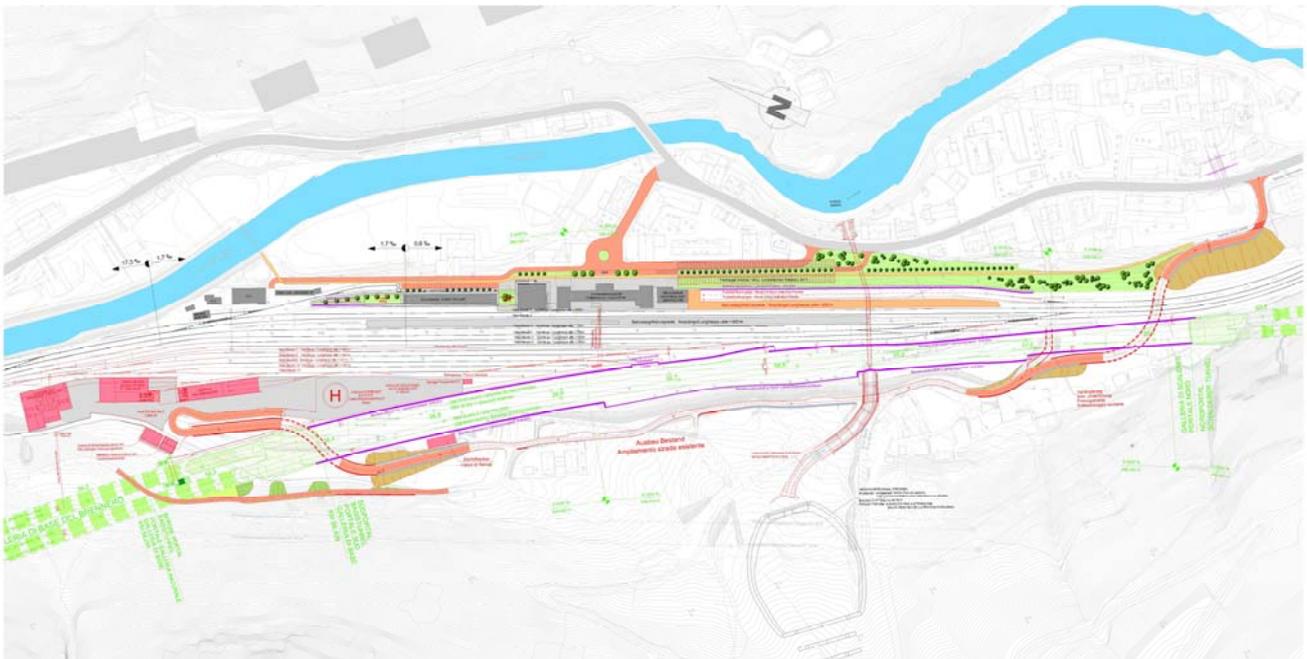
Lageplan des Bahnhofs Franzensfeste
